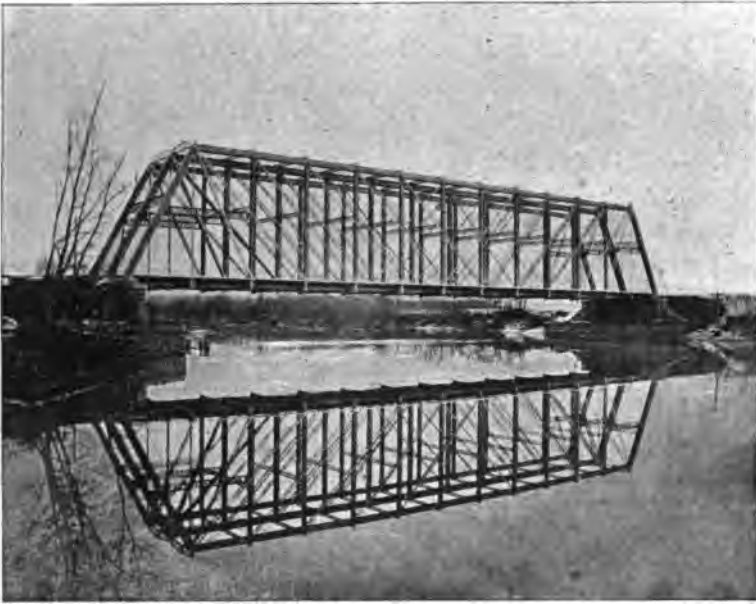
Pont sur le Genesee (Union Bridge Co.)
